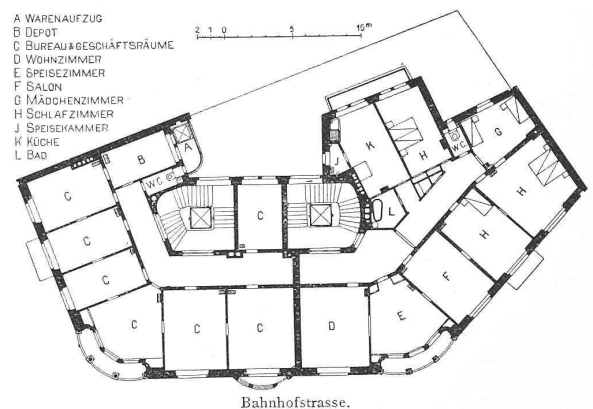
Grundriss vom dritten Obergeschoss. — Masstab 1:500.
